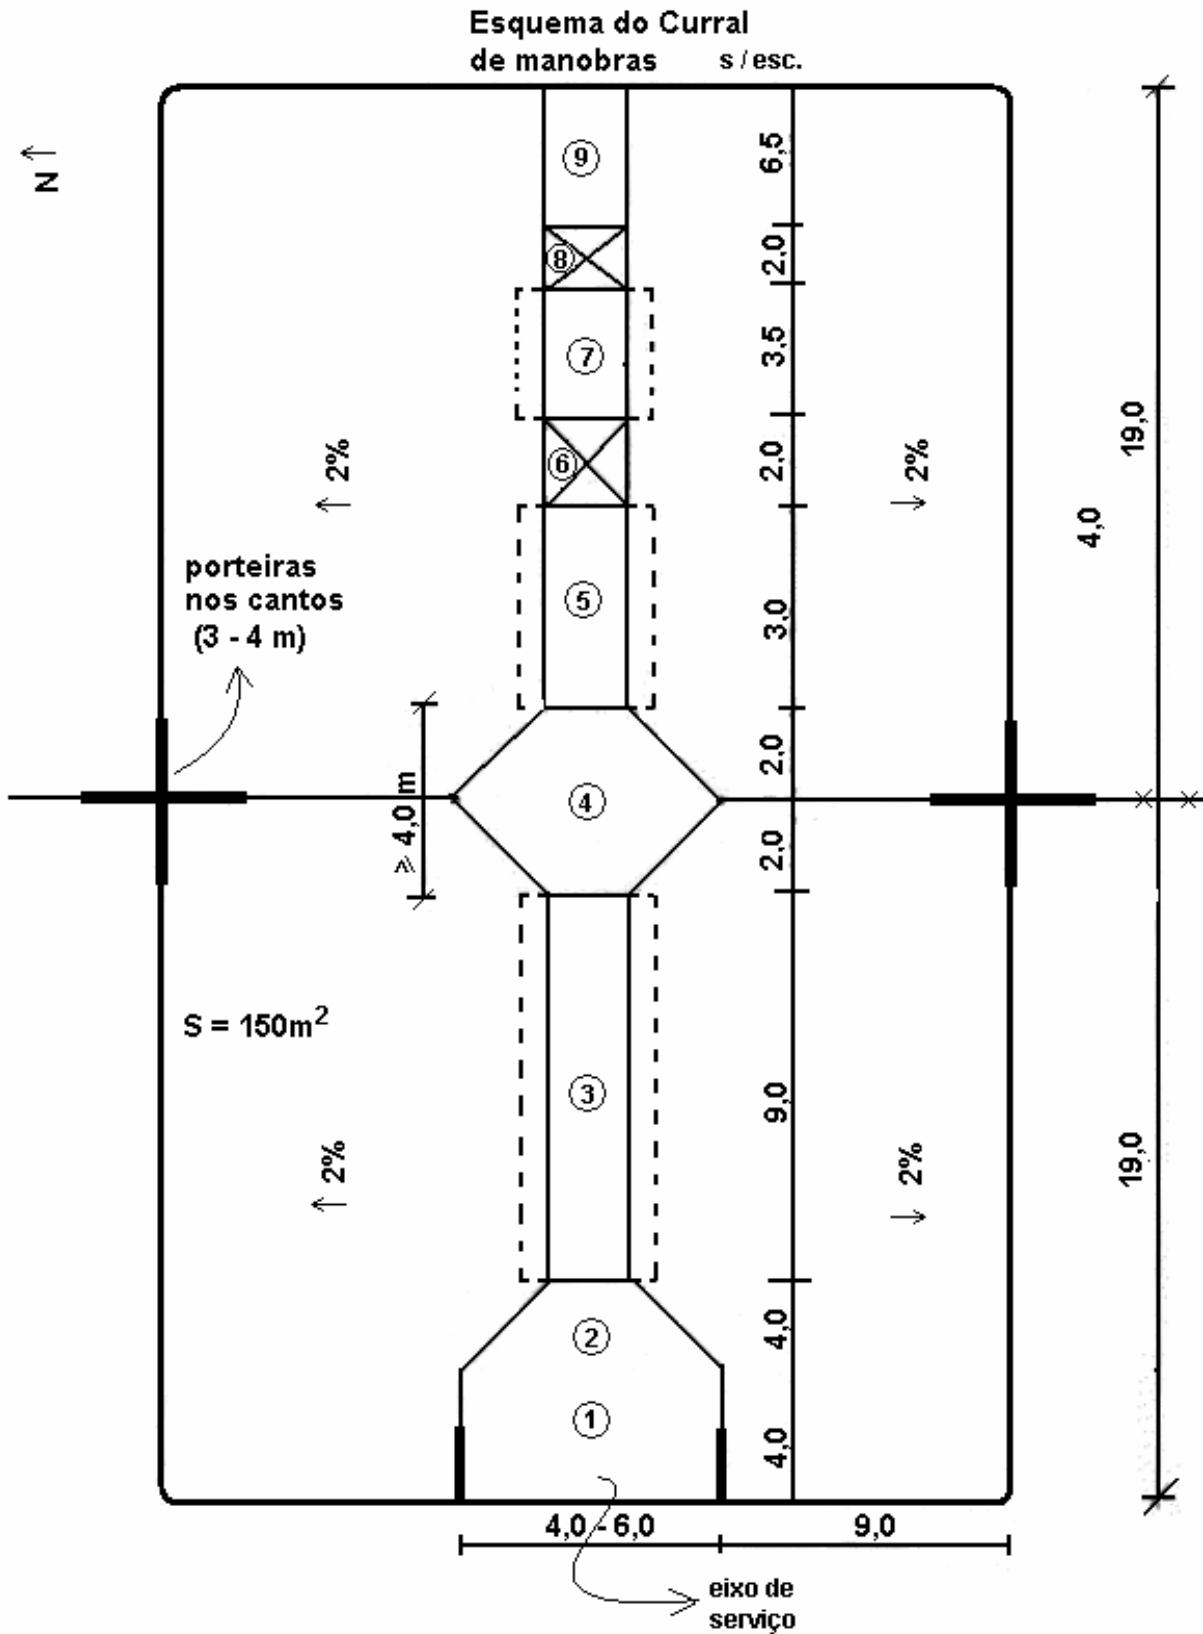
Croqui de curral de manobras dimensionado para 300 bois.
